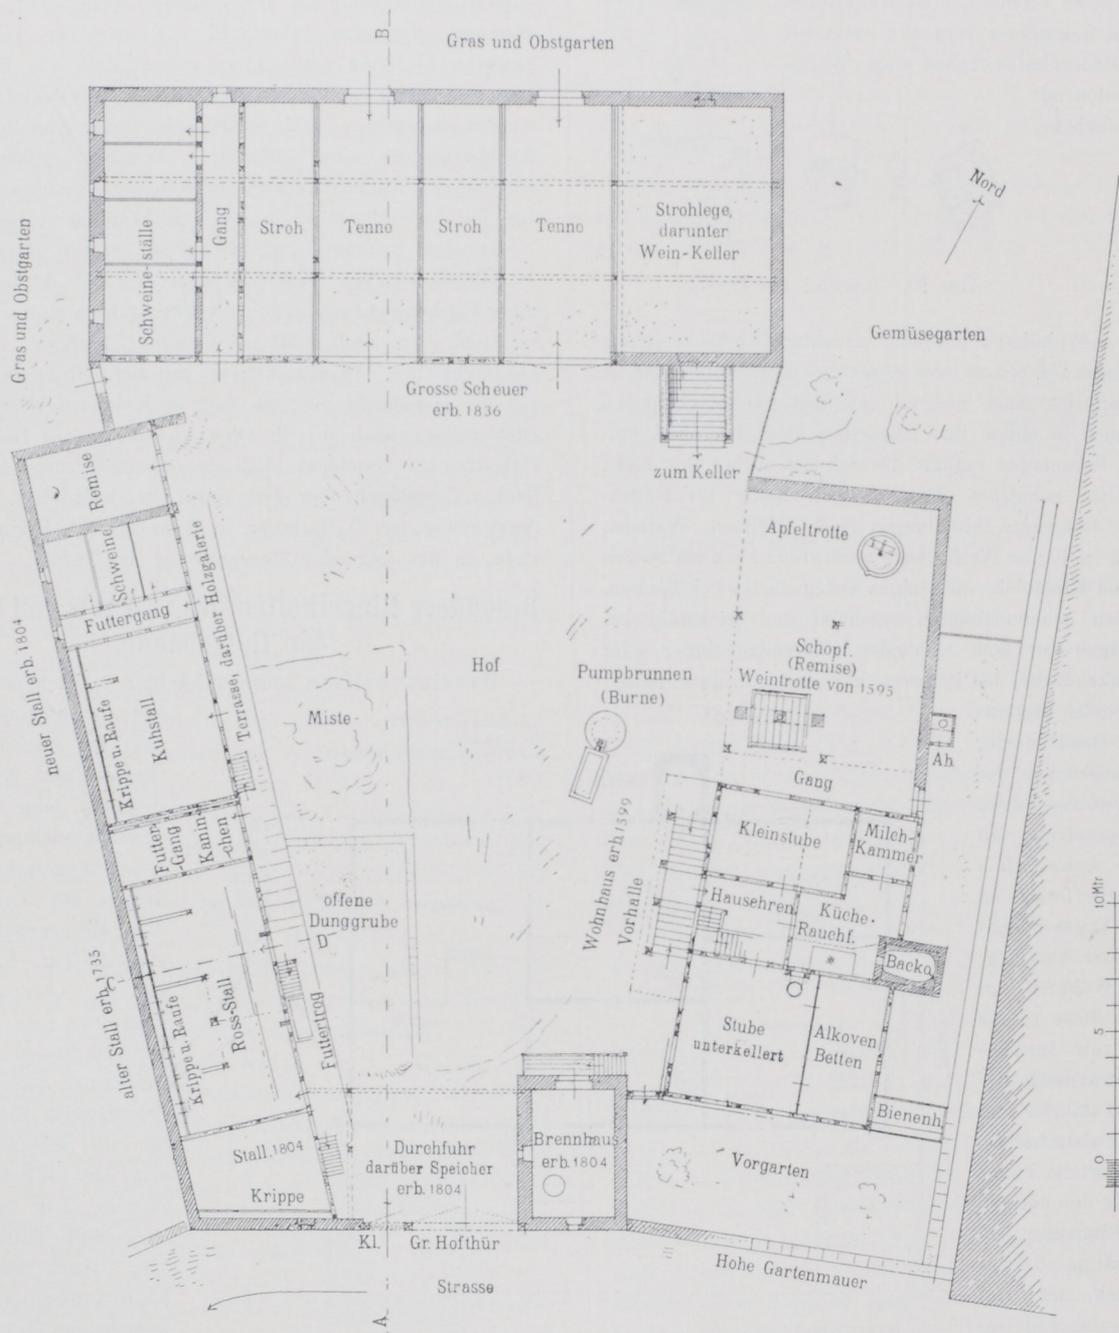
Grundriß der Hofanlage des Bauernhofes Jacob in Büsweiler (Unter-Elsaß).
